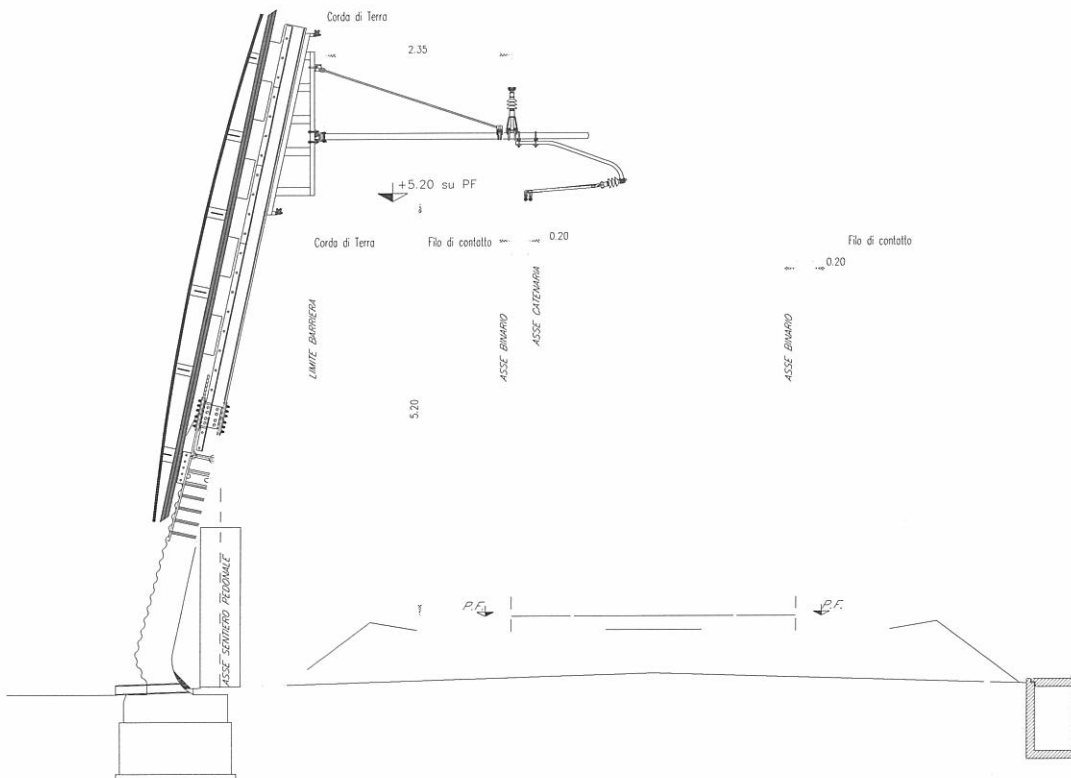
Sezione indicativa sospensione TE su barriera fonoassorbente
